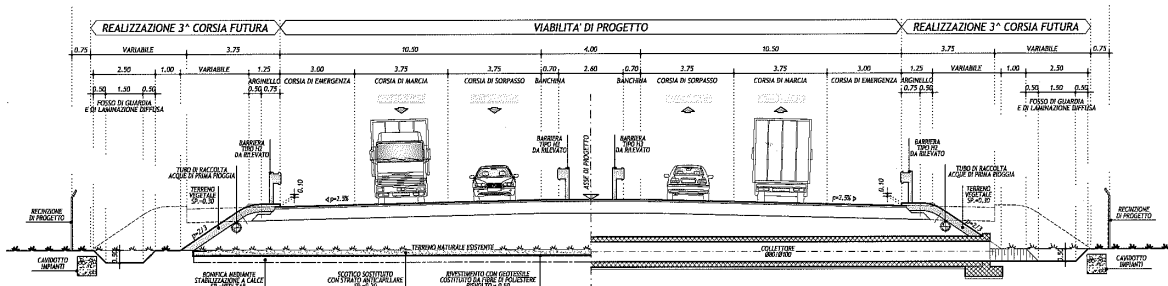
SEZIONE TIPO IN RETTIFILO
